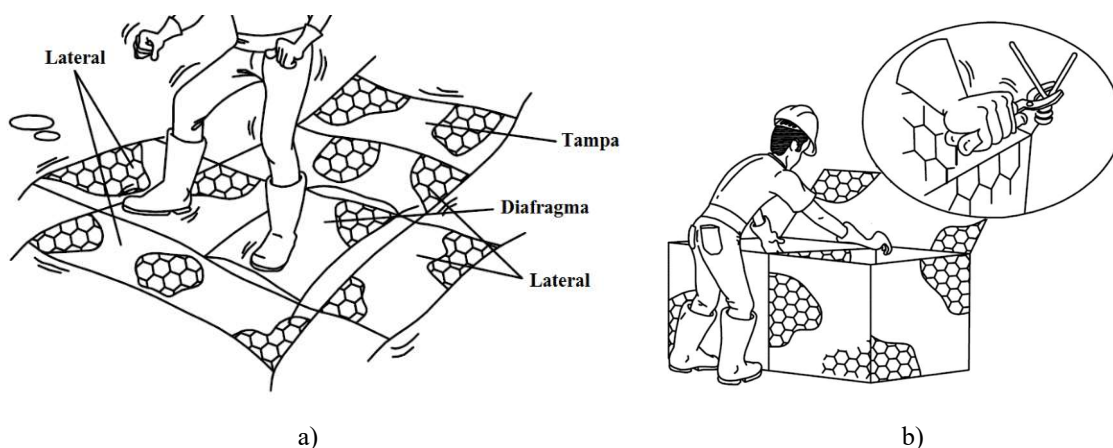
Montagem do gabião tipo caixa; a) abrindo e desdobrando o gabião; b) levantando as arestas para amarração.
